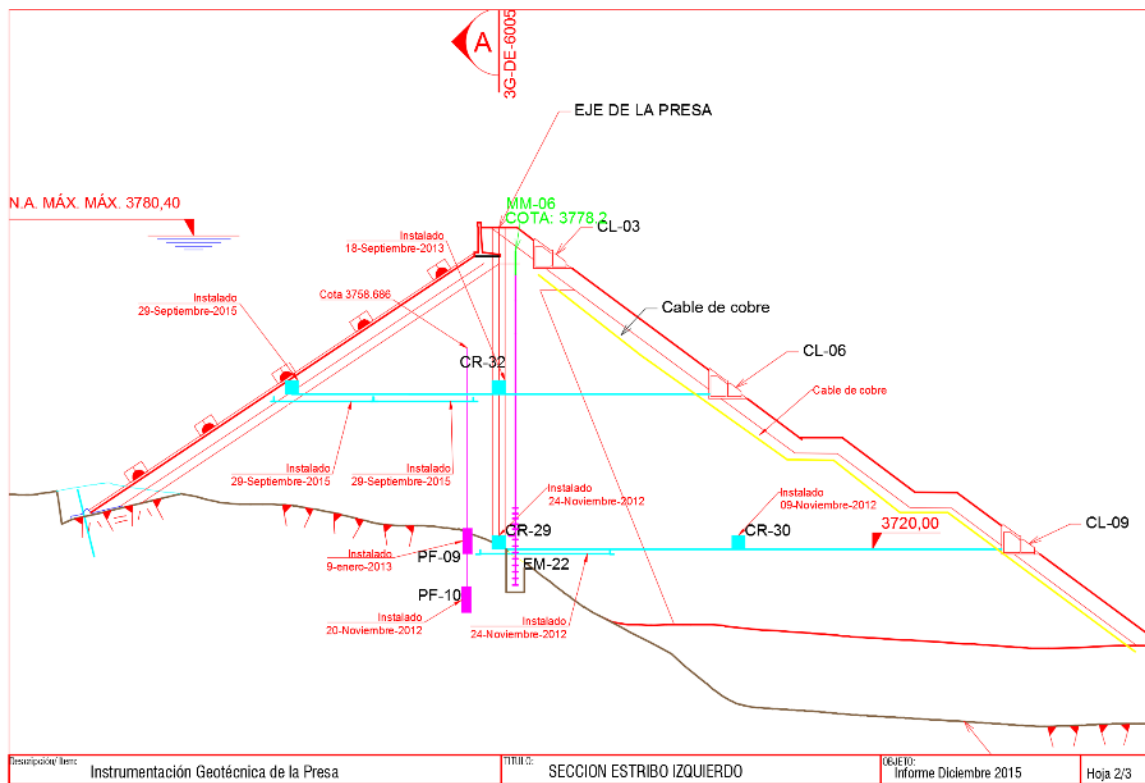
Sección estribo izquierdo de la presa con el detalle de los instrumentos instalados.
